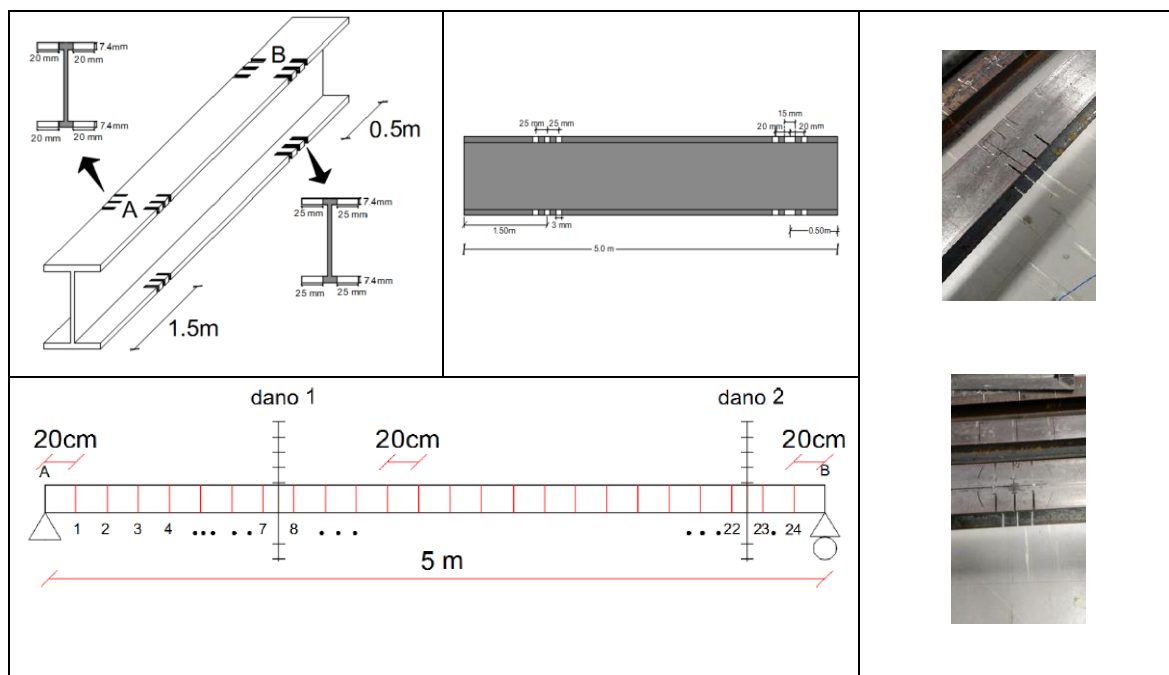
Viga Metálica Biapoiada Danificada: caso 16 (Palechor, 2018)
